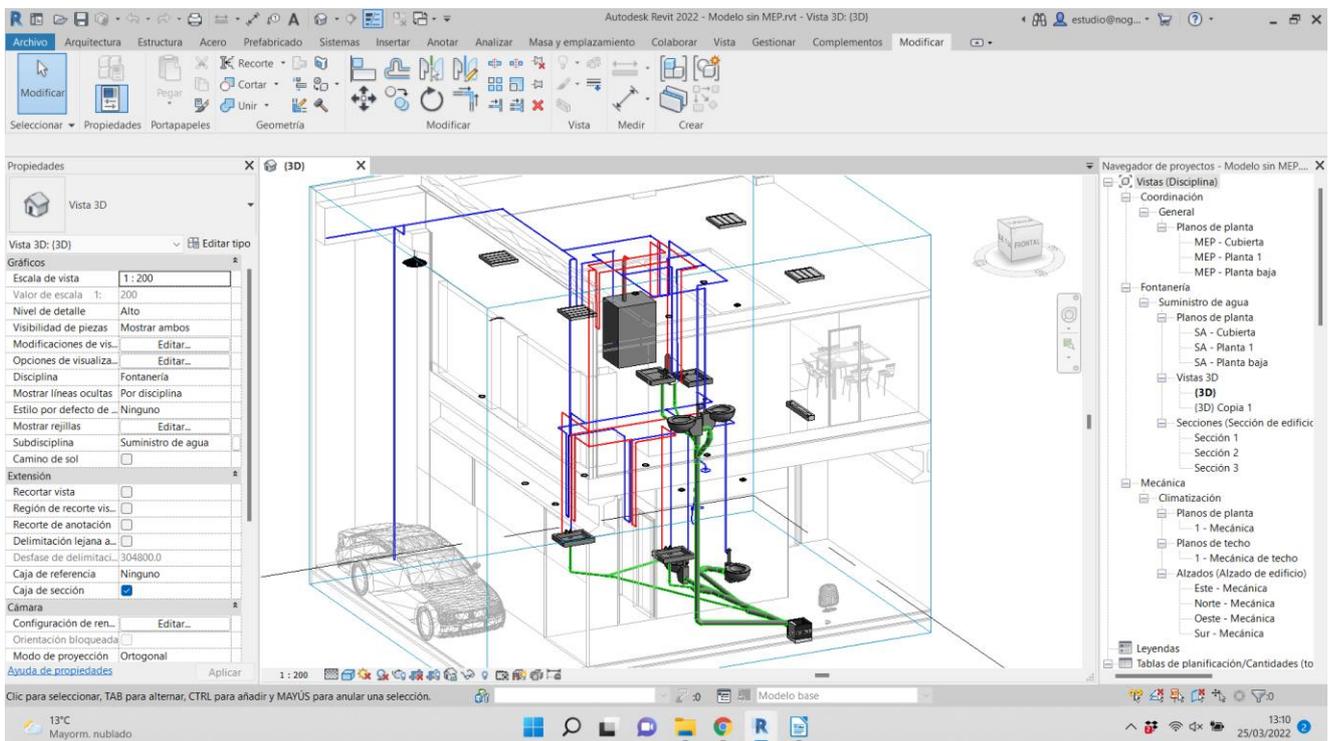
Instalaciones de fontanería y saneamiento en Revit (1).
